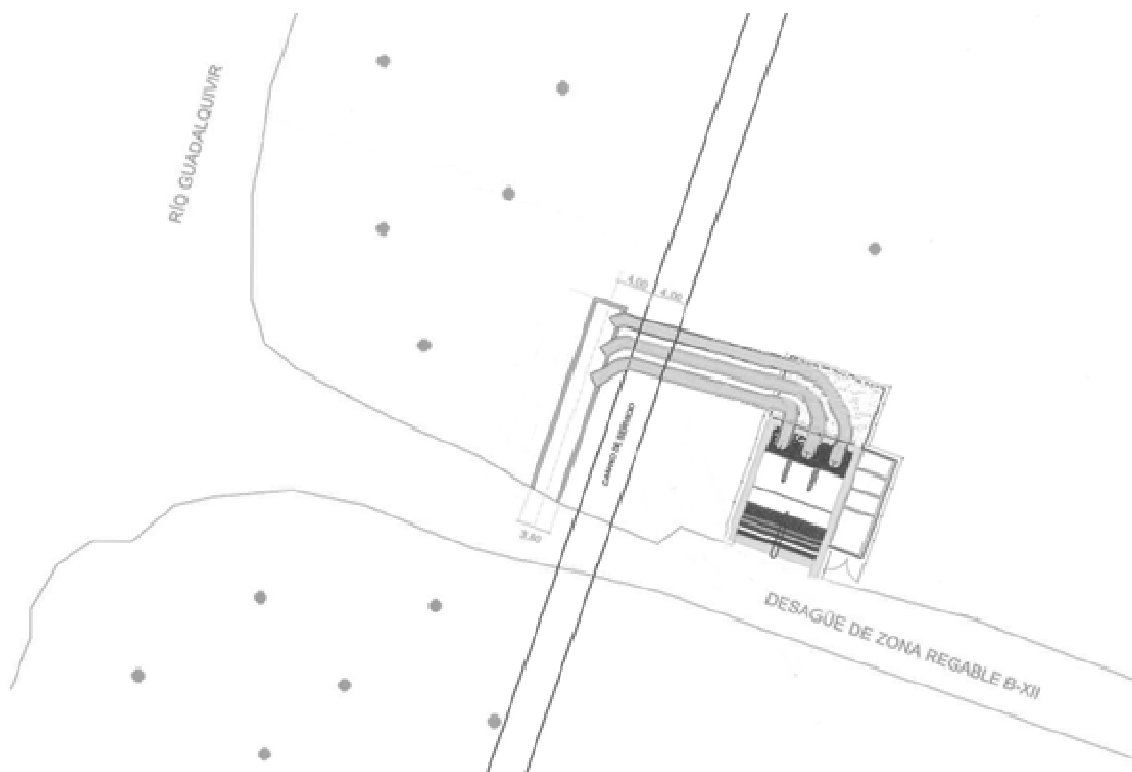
Alternativa 2.- Planta EBAP (margen derecho)
